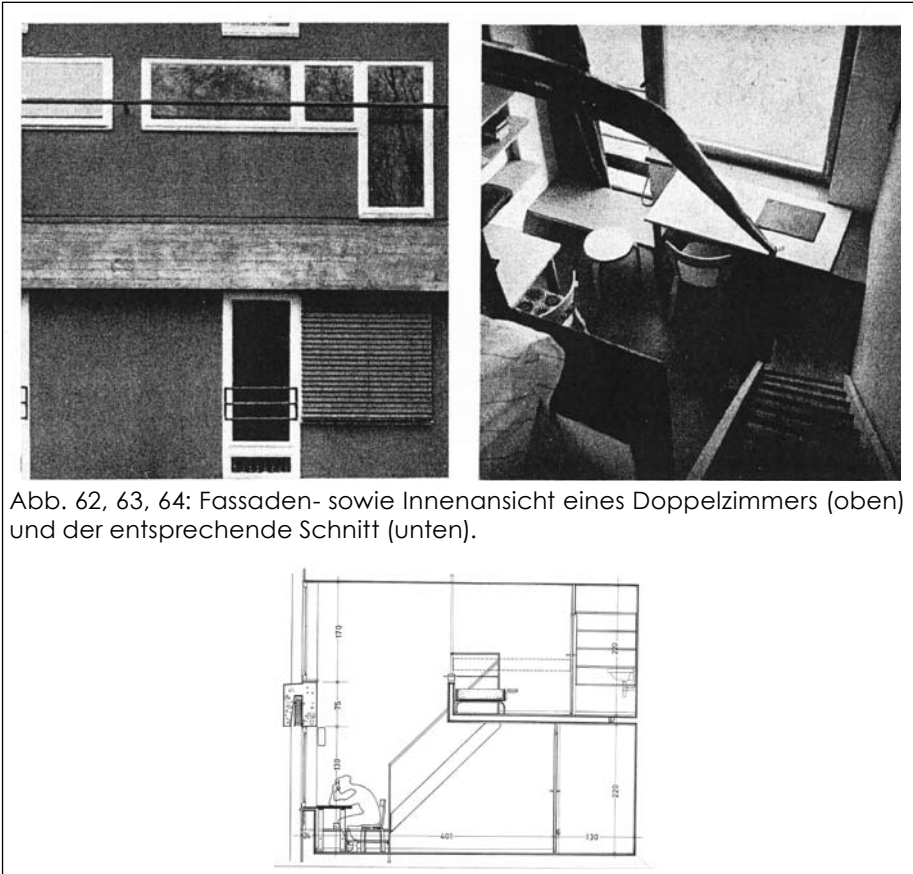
, 63, 64: Fassaden- sowie Innenansicht eines Doppelzimmers (oben) und der entsprechende Schnitt (unten).
